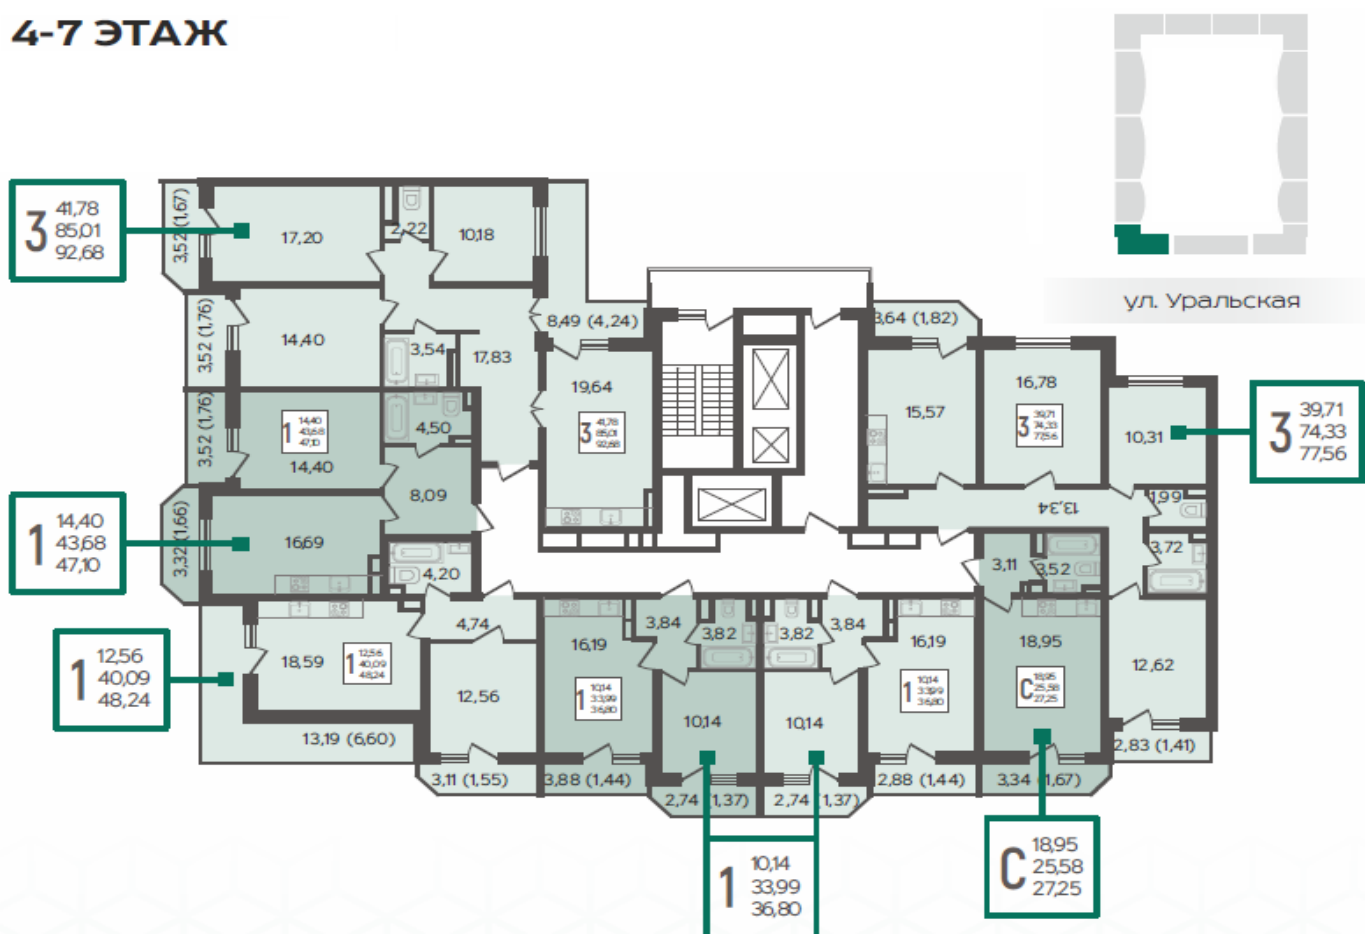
Типовой план 4-7 этажа БС-1 ЖК URAL
